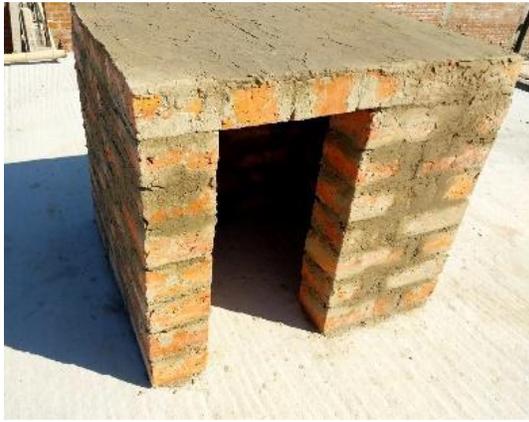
Estructura construida con ladrillos modificados con la incorporación de viruta de cuero.
